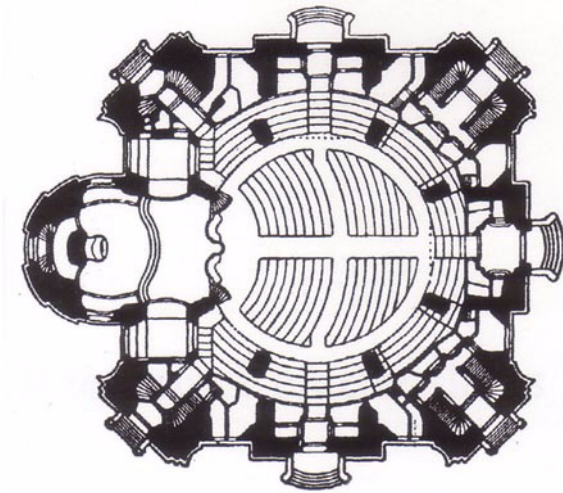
Grundriss der Frauenkirche in Dresden. 1726-1738 von George Bähr.
